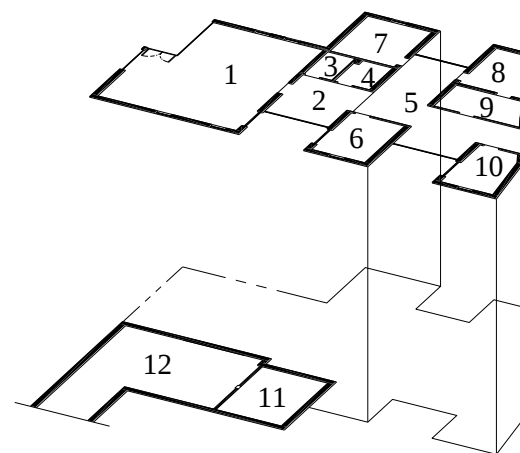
| Planta esquemática do Piso Térreo e Piso -1, Consultas Externas, Edifício 5.
